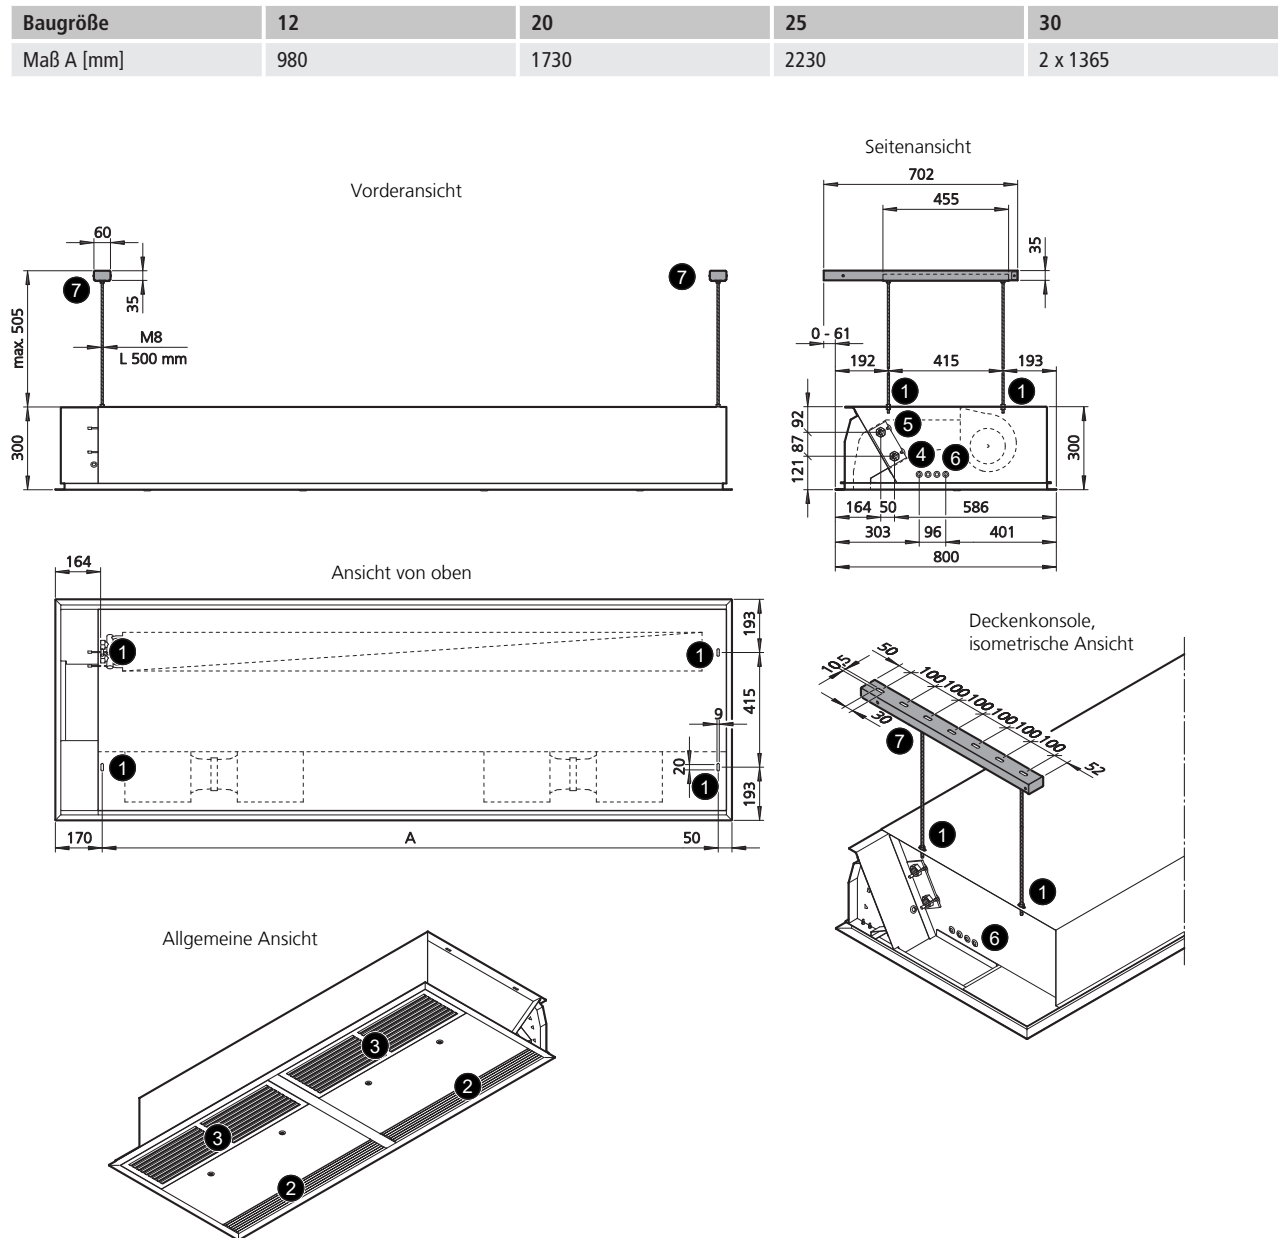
Aufhängepunkte Tandem 300 Deckeneinbau BG 12 - 30 mit Deckenkonsolen
